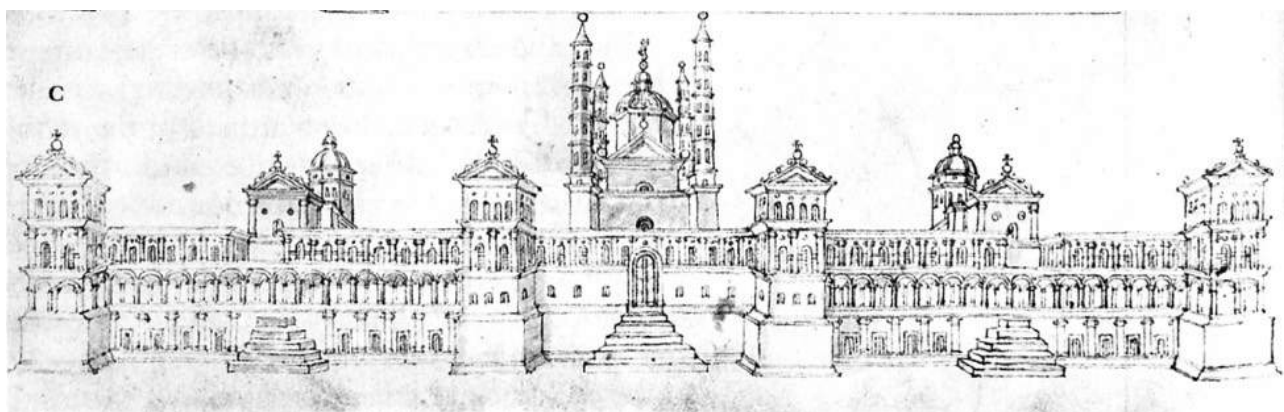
Alzado del Hospital Mayor de Milán en el Tratado de Filarete.
